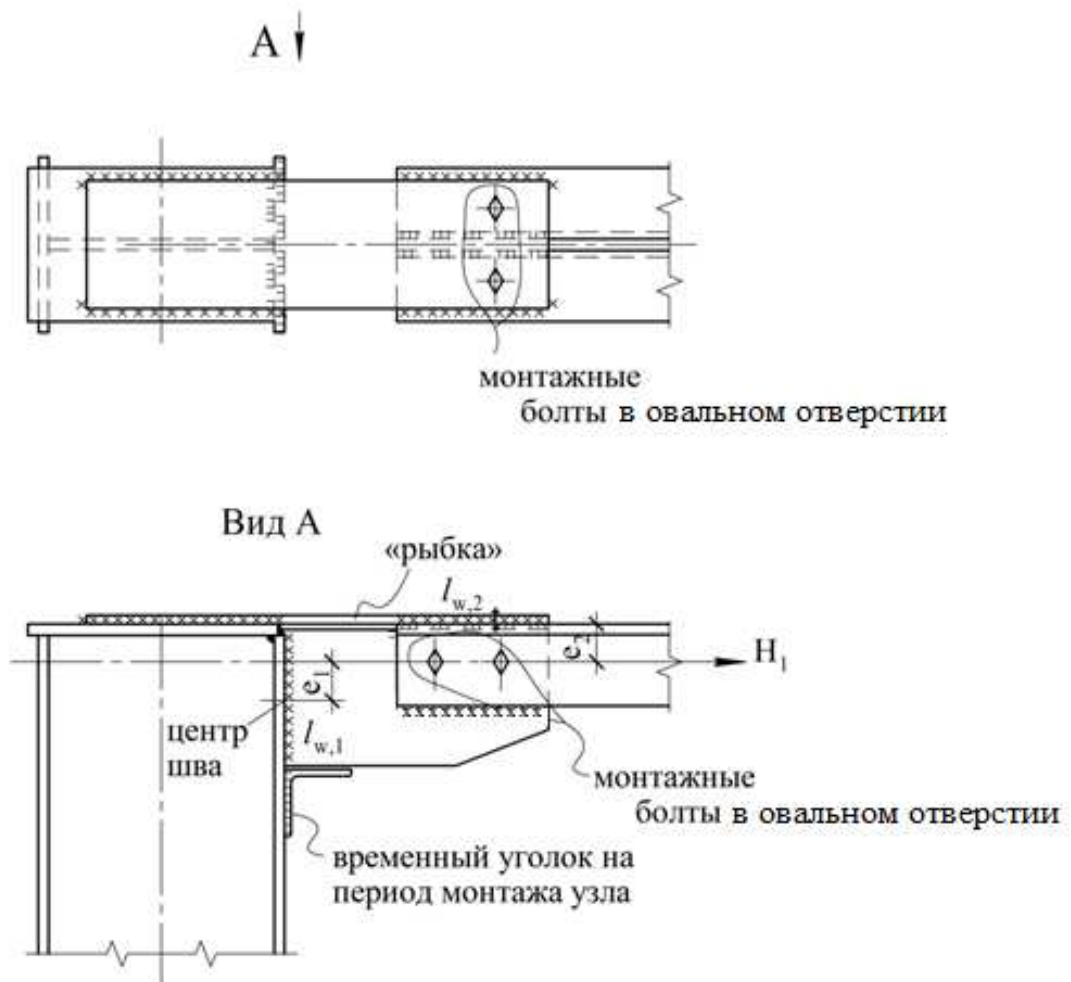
Вариант жесткого крепления верхнего пояса ригеля с применением "рыбки"
